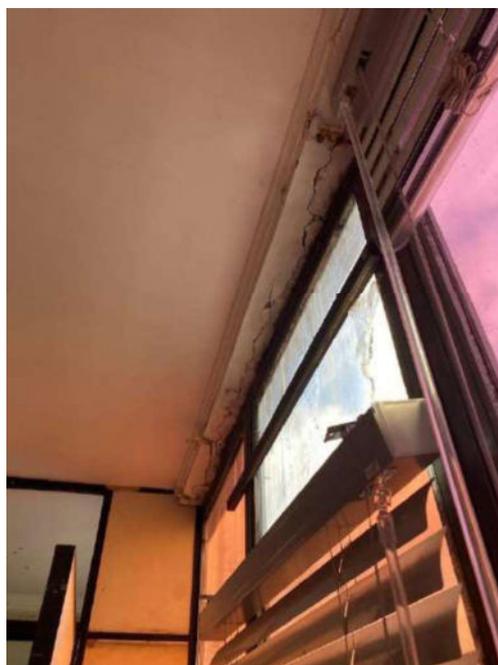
Fissura e deslocamento do concreto de cobertura na viga
